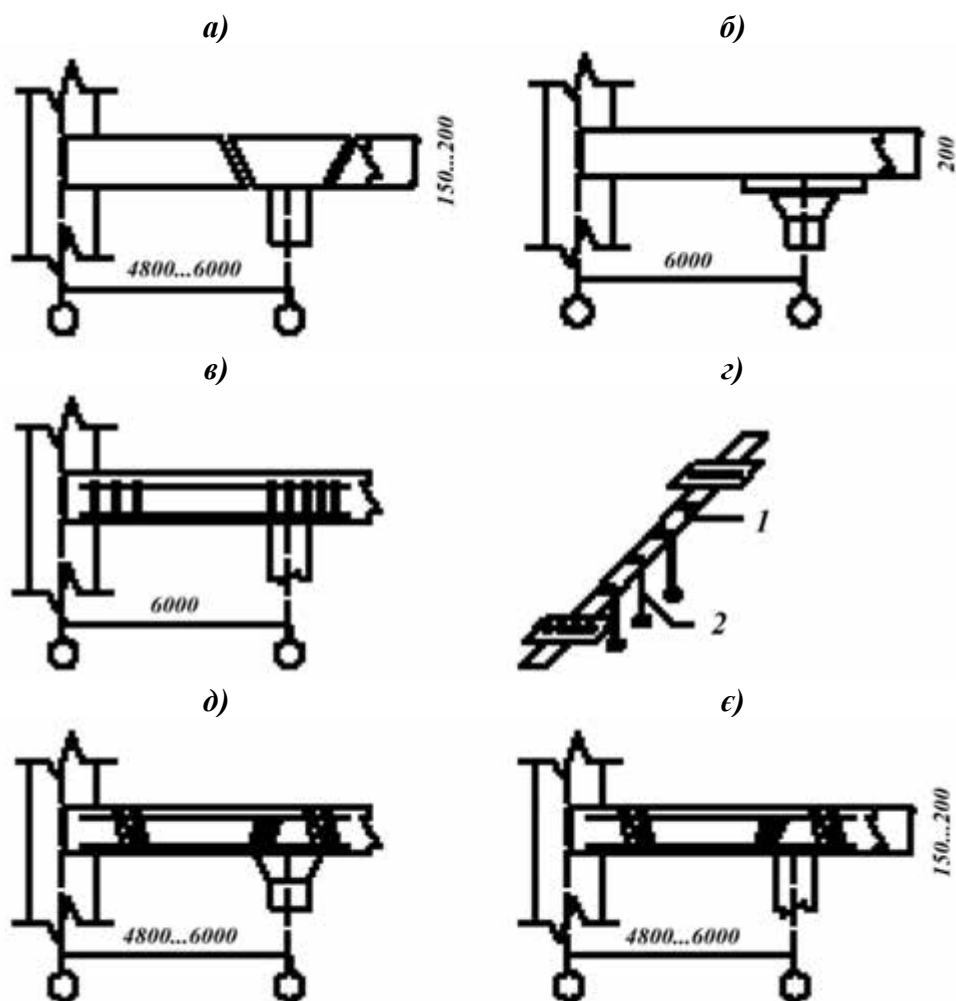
Вузли стикування монолітних плит перекриття з вертикальними опорами:
